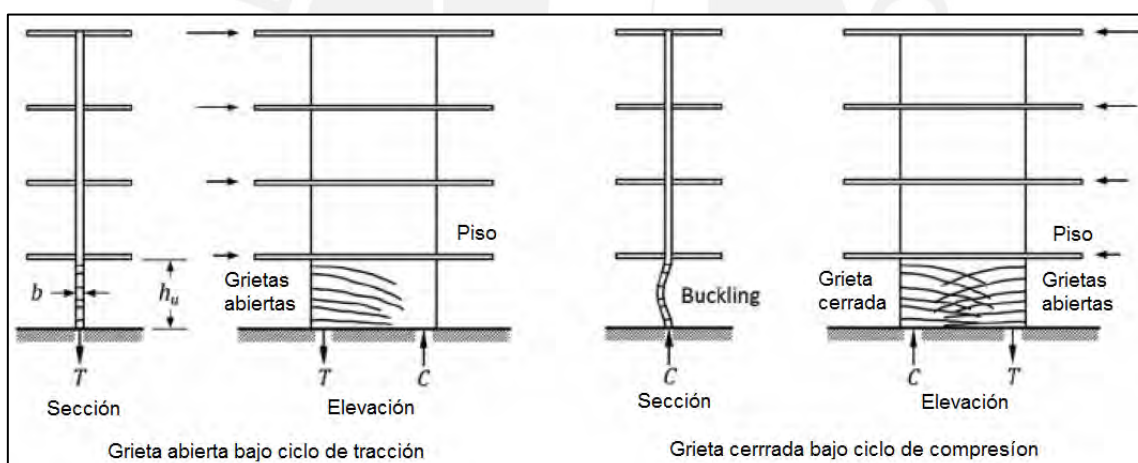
Mecanismo de falla por pandeo global en muro de concreto armado
